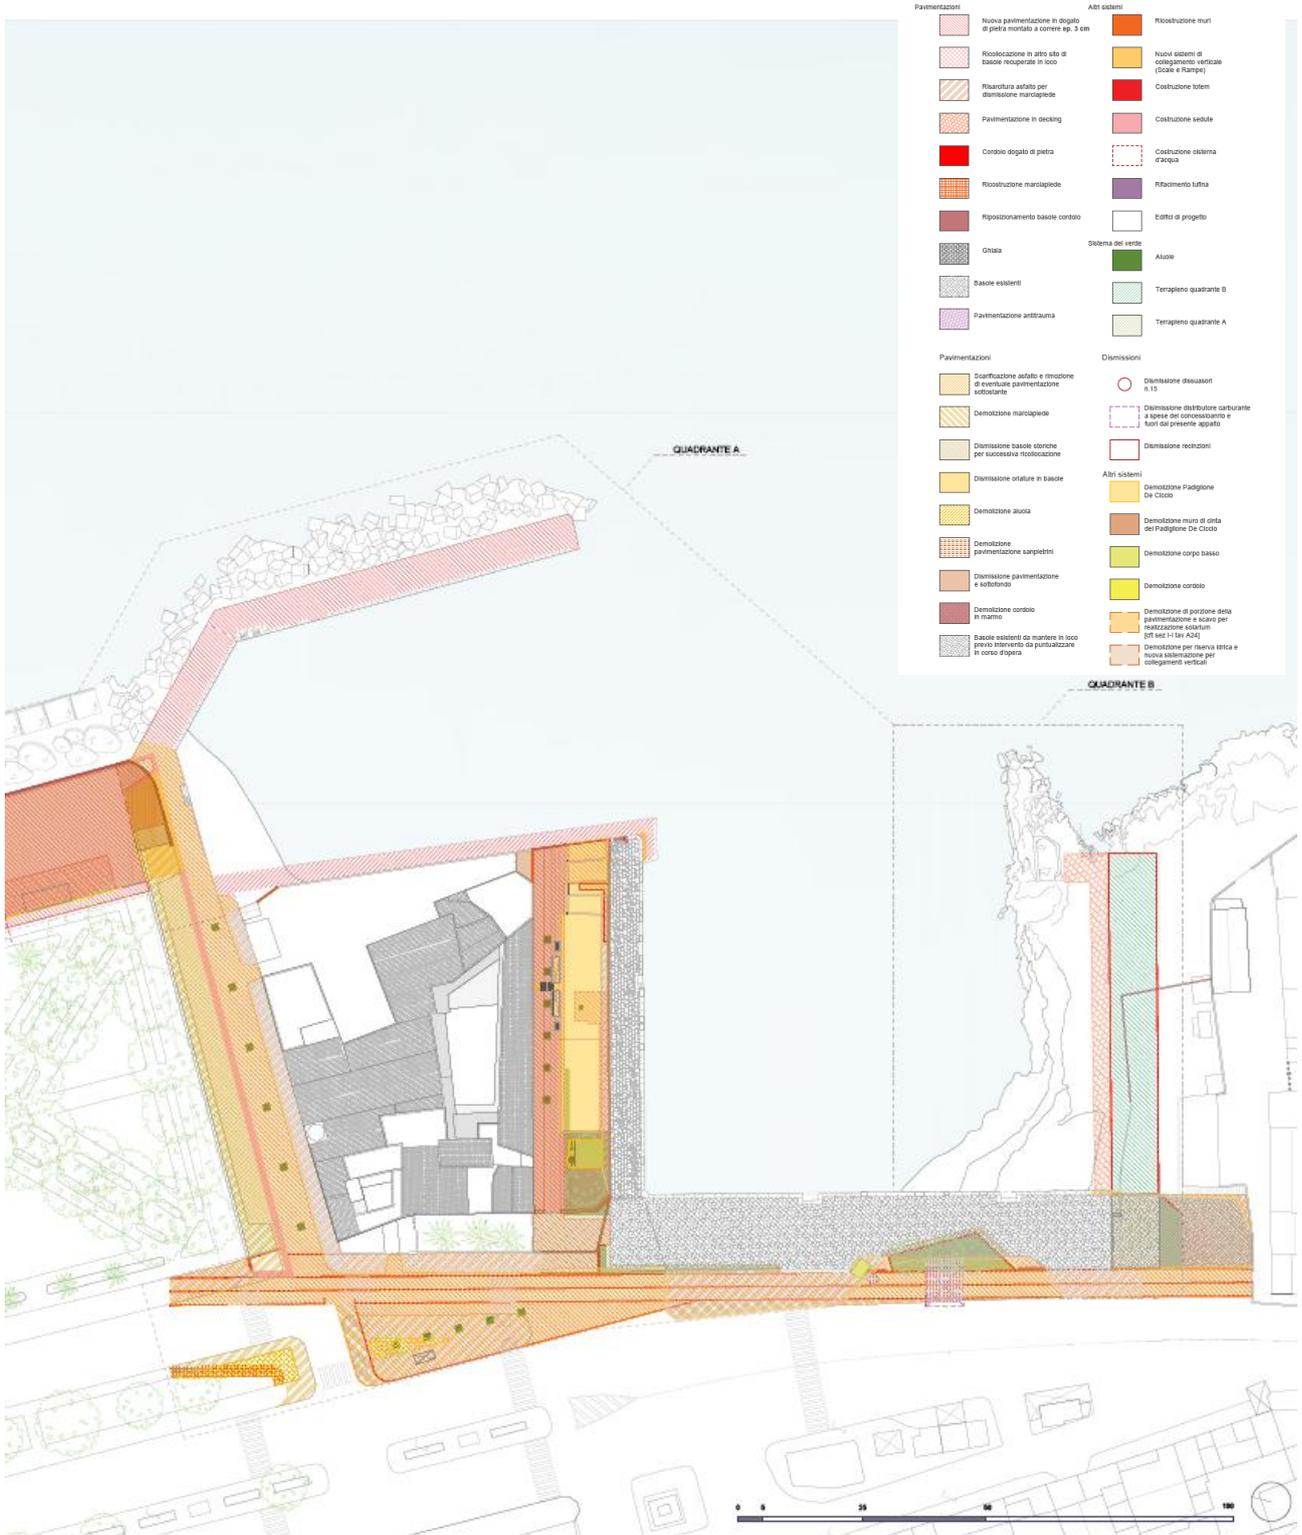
Stralcio progettuale, sovrapposizione stato di fatto/progetto.
